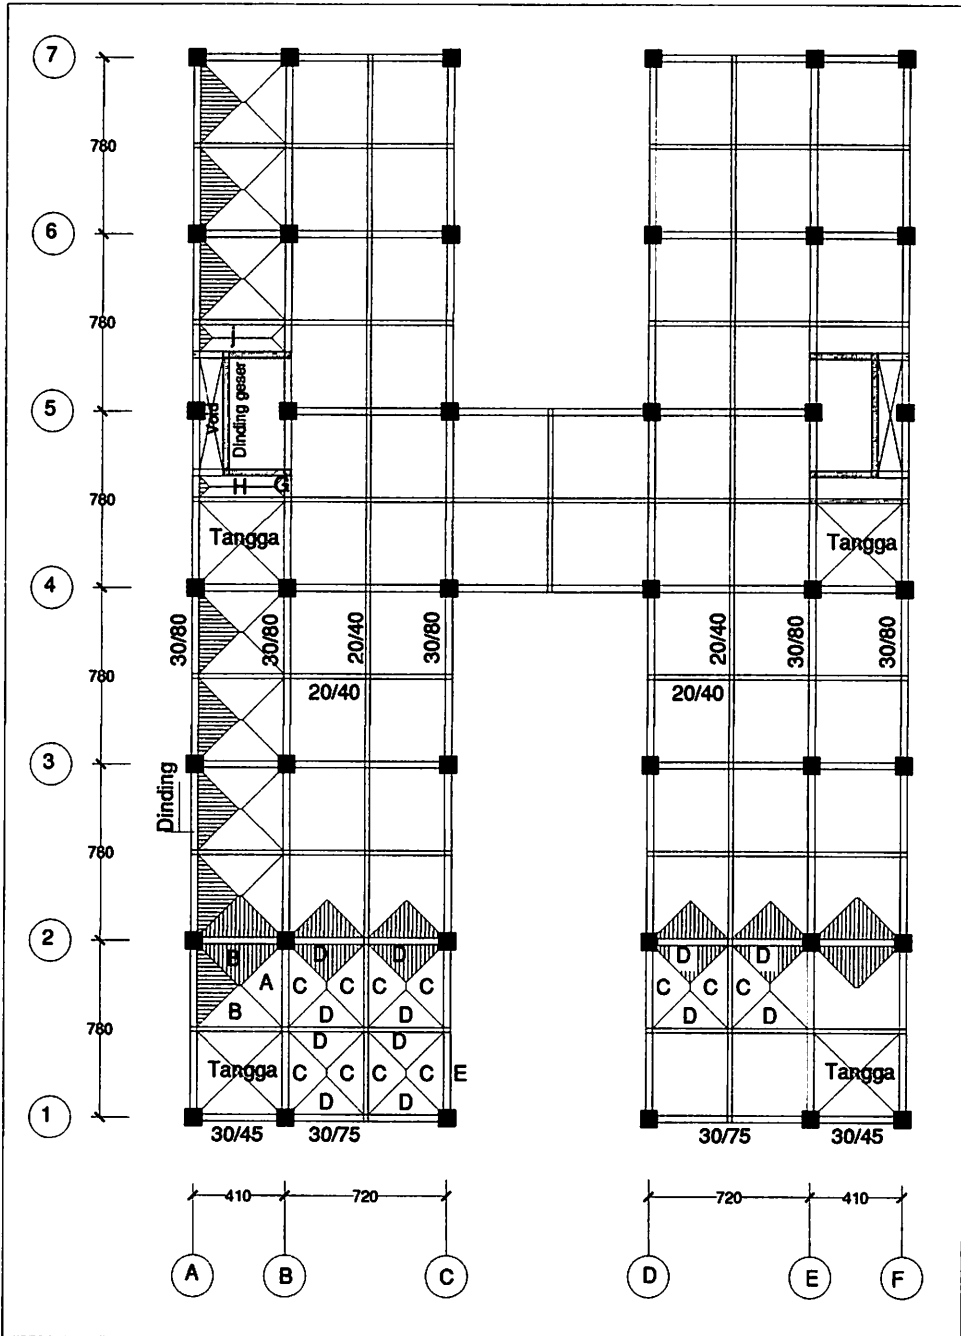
Denah Balok yang terbebani pelat Lantai 3 & 5
